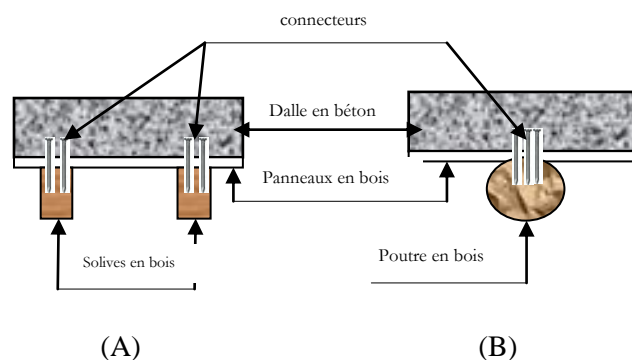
Liaisons ponctuelles des planchers mixtes bois-béton.
